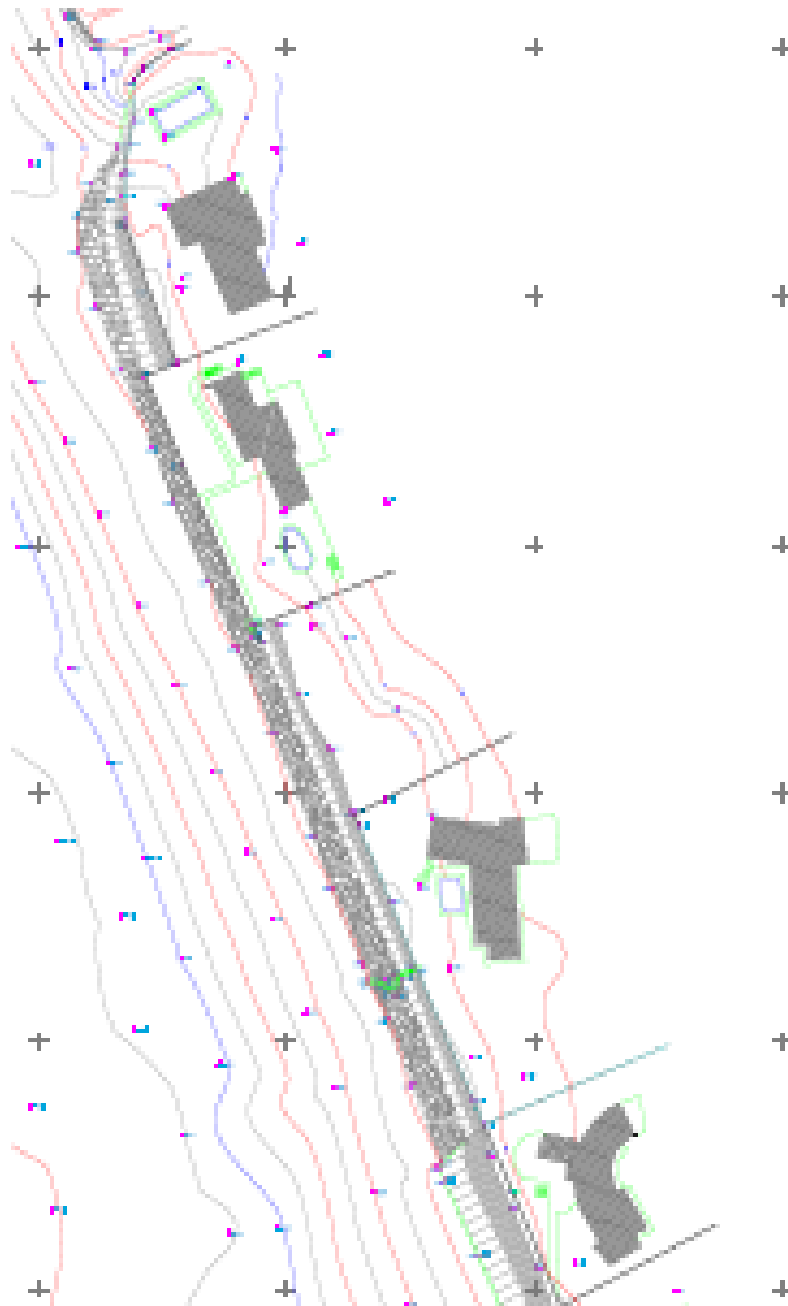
Pormenor do levantamento topográfico a norte, entre a 5ª e a 8ª vivenda (a contar de sul para norte)
